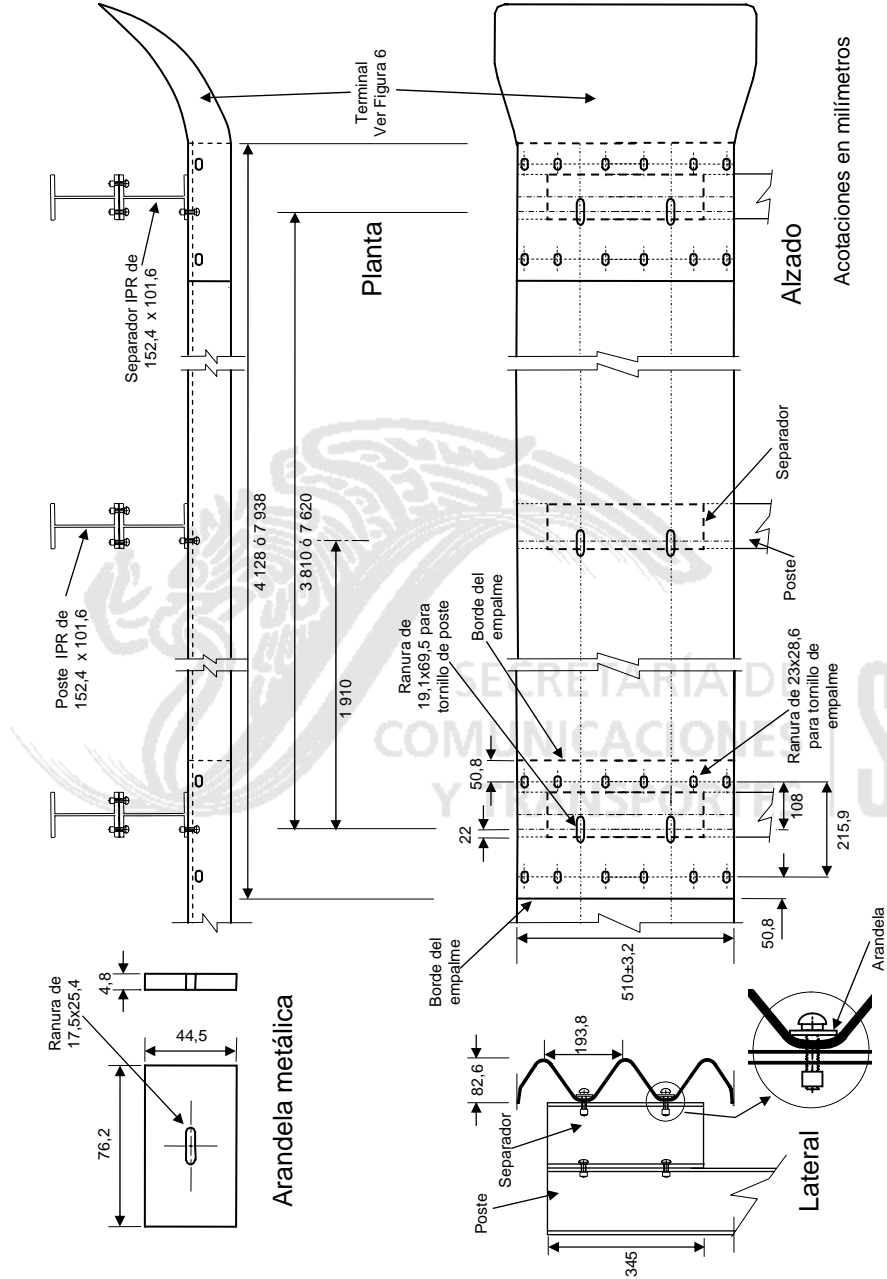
Sistema de defensa con vigas acanaladas de tres crestas
